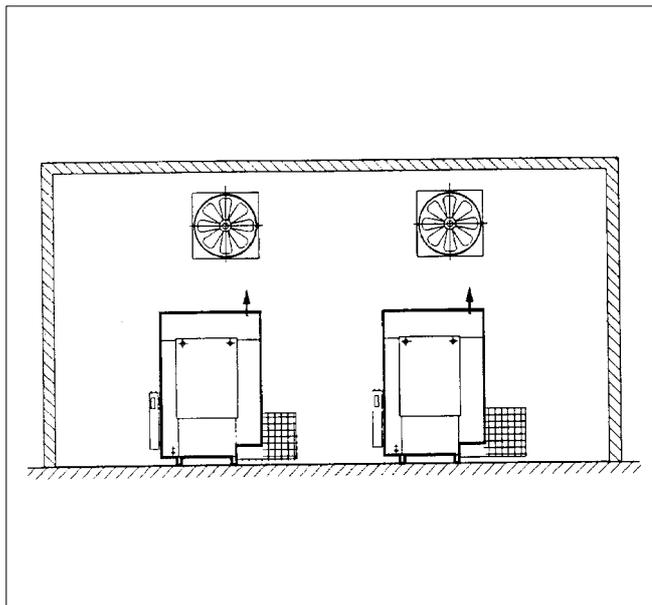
Installationsbeispiel für Mehrfachinstallationen
